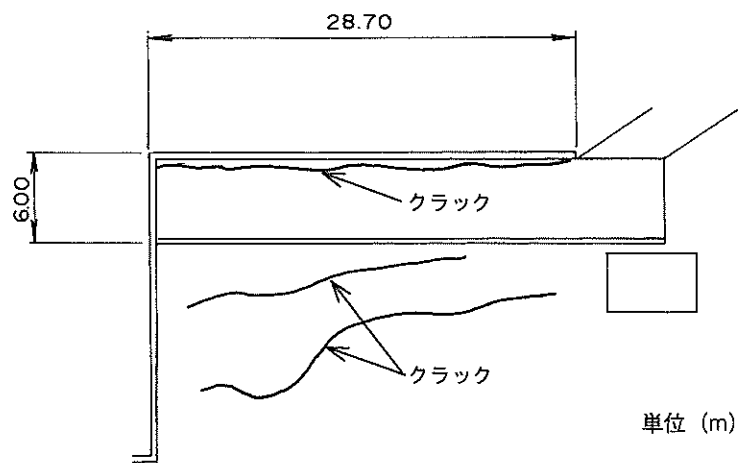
物揚場(-3.5m) (施設番号⑤)の平面図
